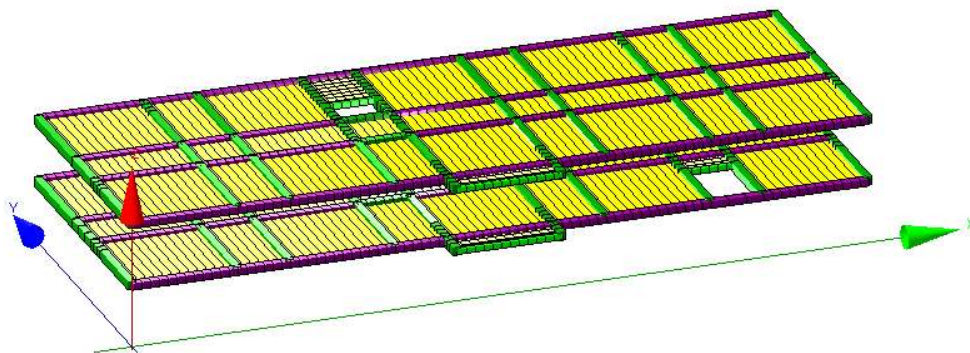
Рассматриваемая расчетно-аналитическая модель диска перекрытия на уровне 1-го и 2-го этажа здания на отм. +3.6 м и +7.2 м с учетом сборной ж/б многоспустотной плиты перекрытия, монолитных участков (перекрытий, лестничных площадок), ригелей и ребер жесткости ж/б каркасной системы
